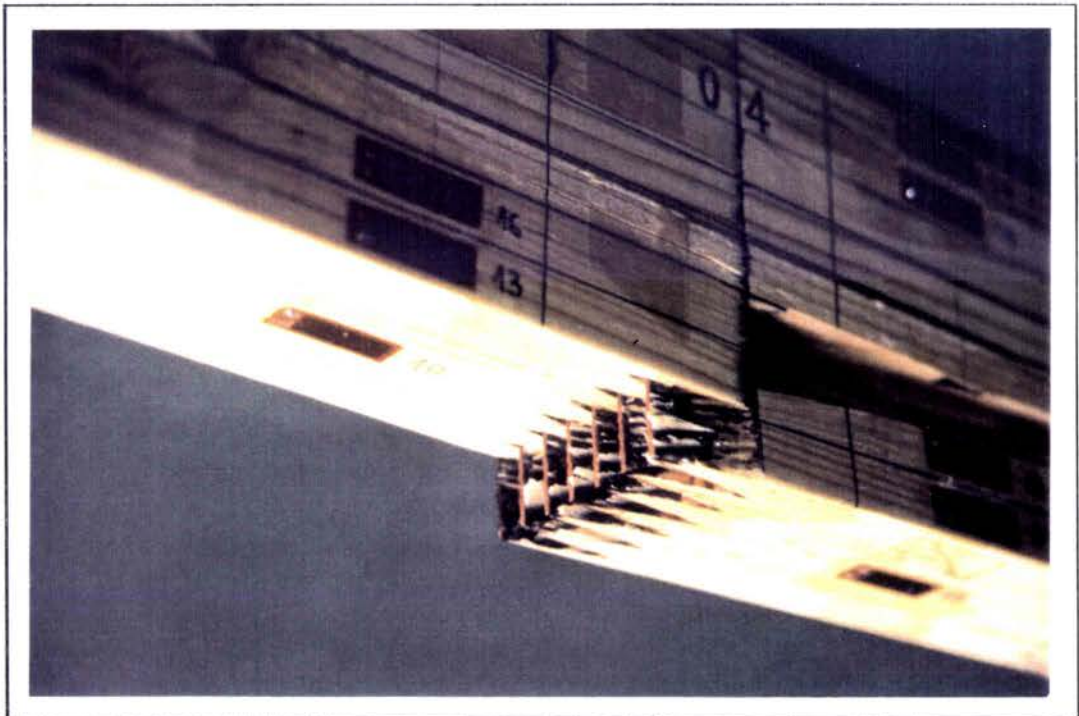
Détail de la rupture au niveau du plan des entures des poutres assemblées.
